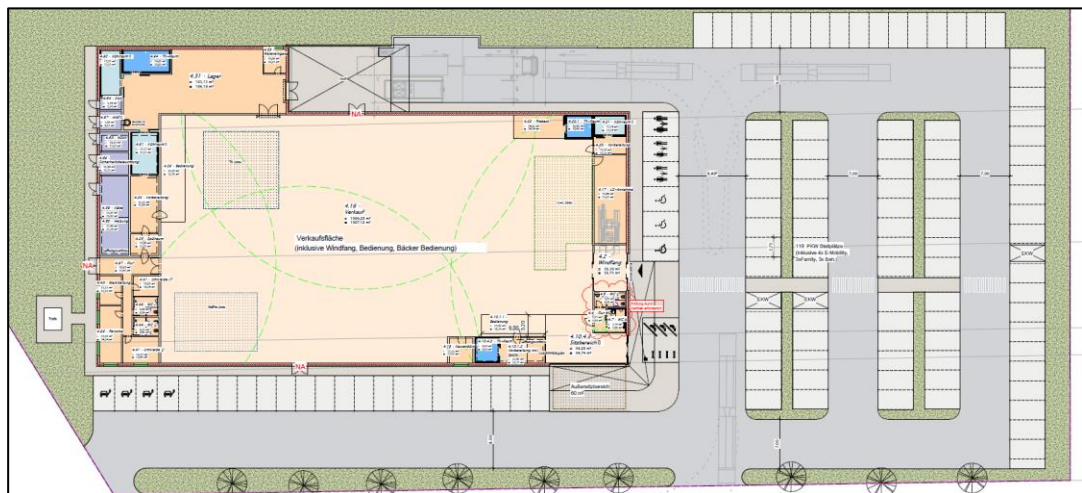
Lageplan zur Grundstücksbebauung<sup>4</sup>
